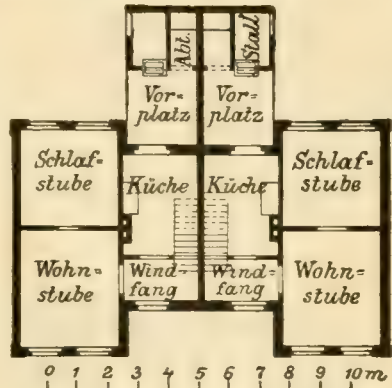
Einfamilienhäuser der Firma Gebr. Howaldt in Kiel. Grundriss der Erdgeschosse.
